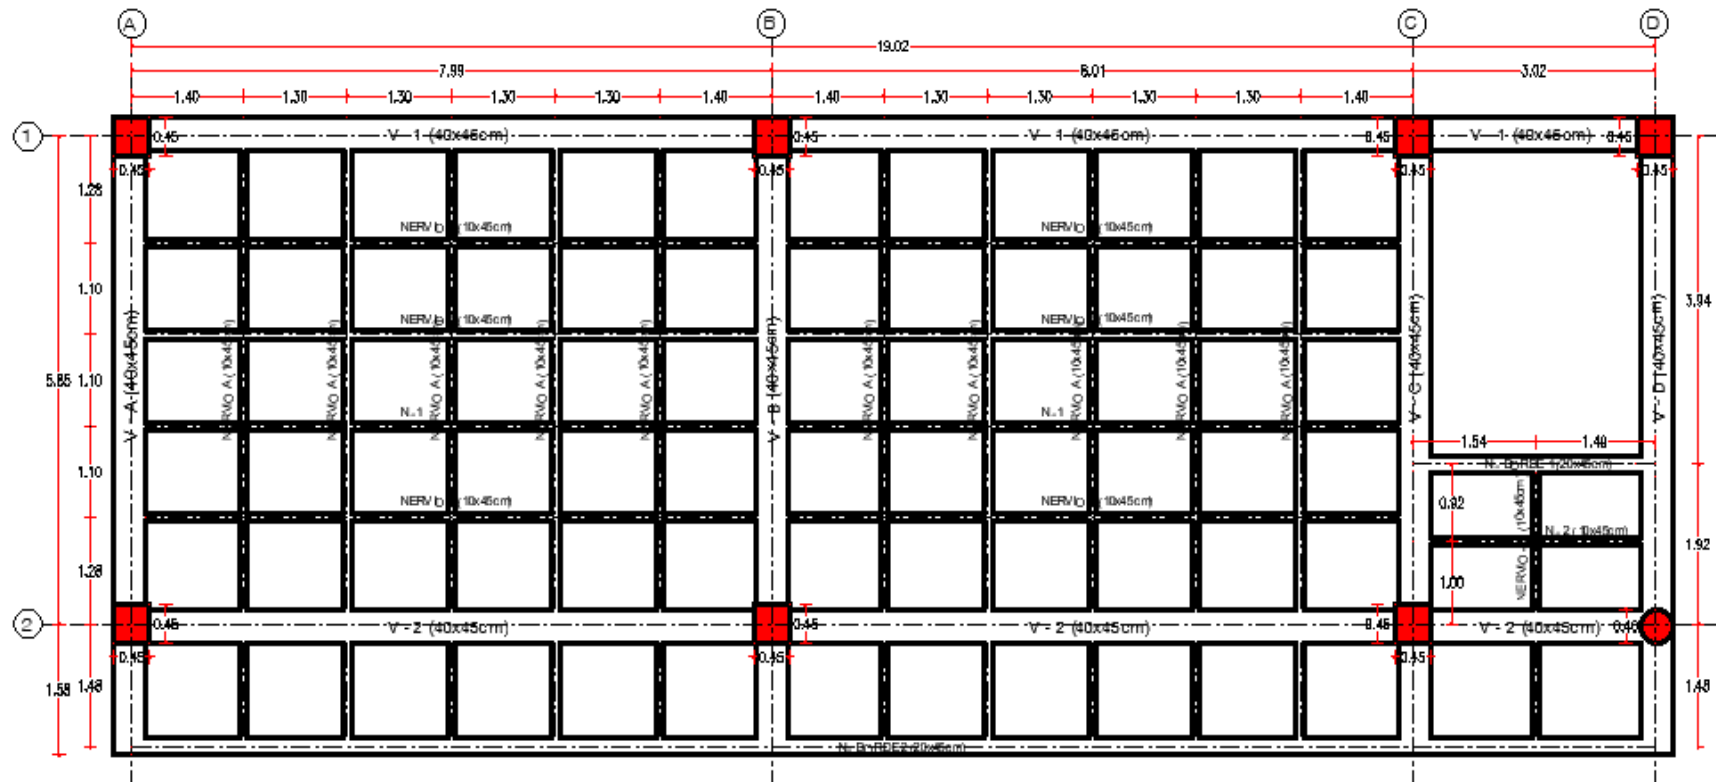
Vista en planta de vigas de entrepiso (Elaboración propia).
